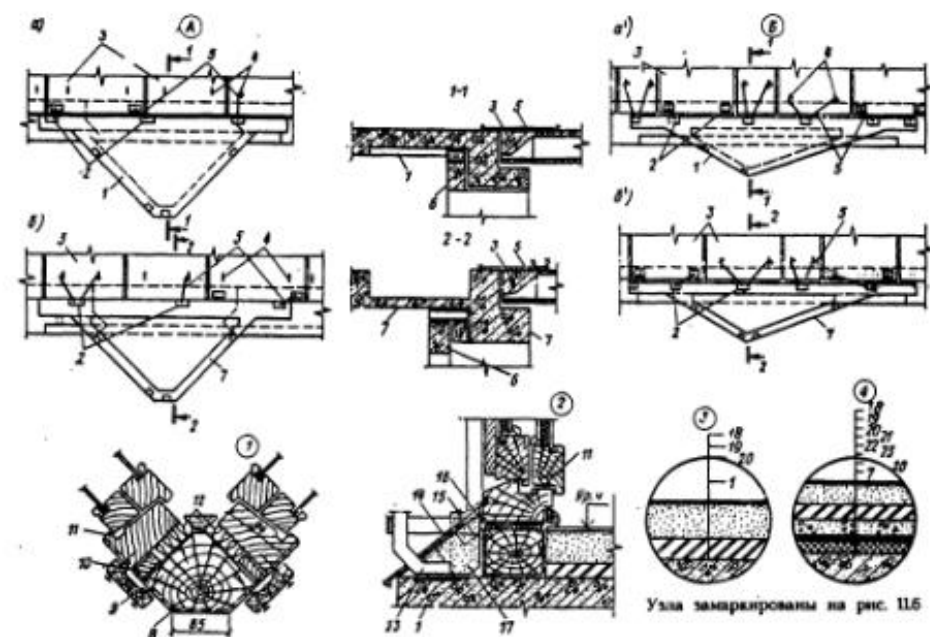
Схемы и узлы крепления эркеров (А - симметричная; Б - асимметричная) в кирпичных зданиях: а, а' - в уровне междуэтажных перекрытий; б, б' - над первым этажом; 1 - керамзитобетонная плита эркера; 2 - закладная деталь; 3 - панель перекрытия; 4 - монтажные петли; 5 - соединительные анкеры; 6 - железобетонная перемычка над проемом; 7 - нижняя керамзитобетонная плита эркера над первым этажом; 8 - деревянный импост; 9 - наличник; 10 - доска; 11 - блок балюнной двери; 12 - конопатка; 13 - стойка металлического ограждения; 14 - костыли по деревянным пробкам; 15 - фартук из оцинкованной стали; 16 - антисептированный брус, оклеенный толем; 17 - цементно-песчаный раствор; 18 - линолеум на мастике; 19 - гипсоцементобетонная плита; 20 - древесноволокнистая плита; 21 - шлакобетон; 22 - слой толя; 23 - минераловатный войлок
